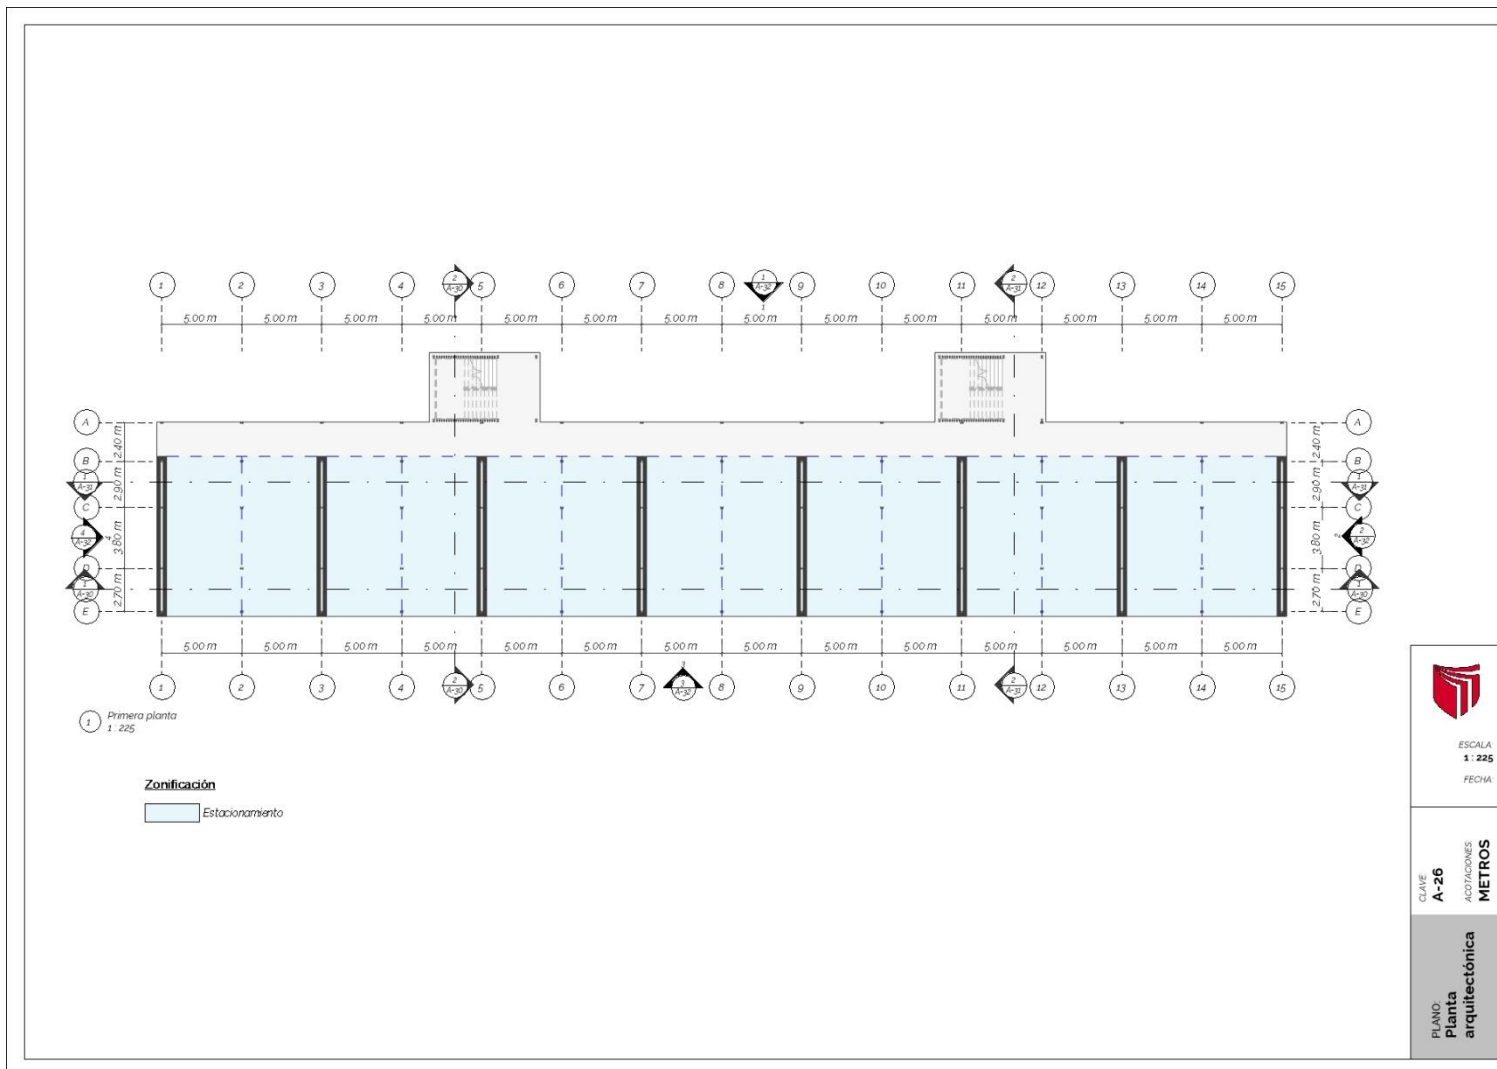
Planta arquitectónica hotel hab. Suites (primera planta)
